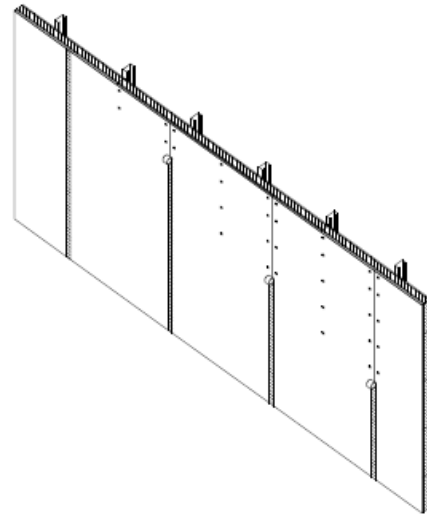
Tratamiento de juntas de las placas de yeso laminado sobre paneles WALL.
